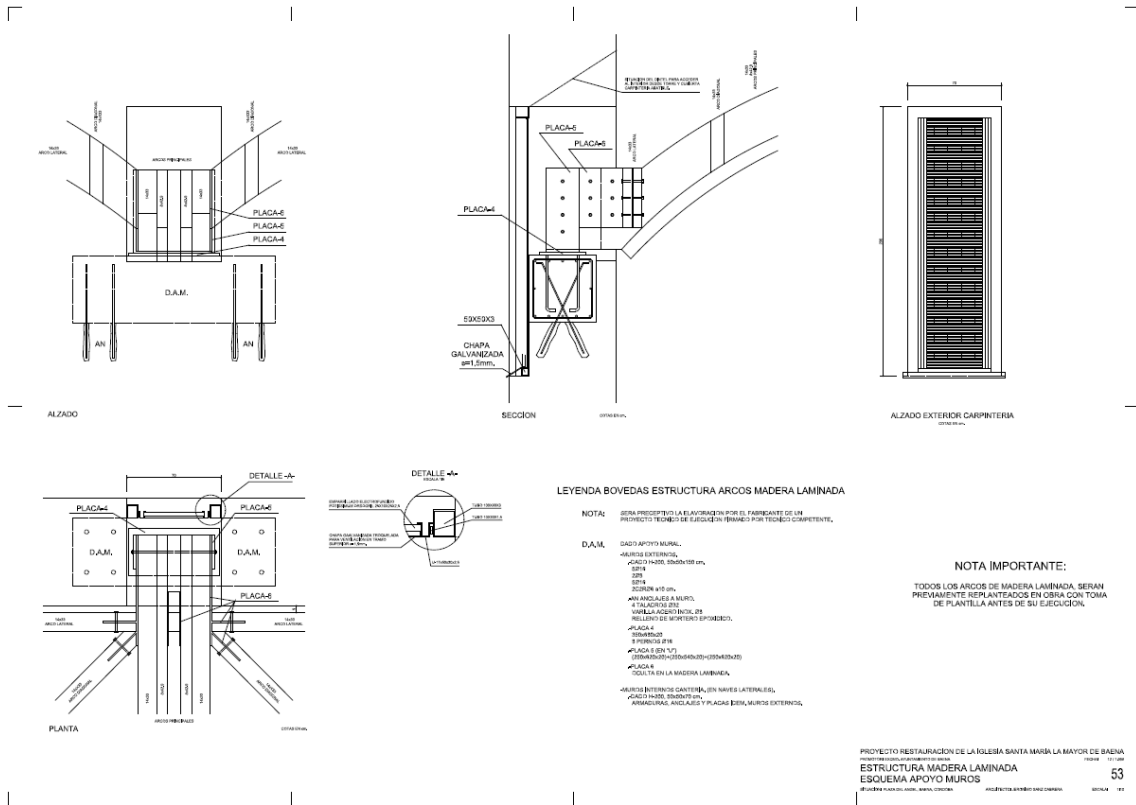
Detalles constructivos de las bóvedas de madera laminada, plano del proyecto de restauración redactado por el autor.
